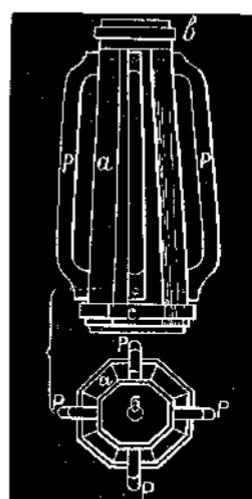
Ручная баба восьмиугольная поперечного сечения: а—баба, б—болть, с—чугунный поддонъ, в—бугель, р—ручки.
